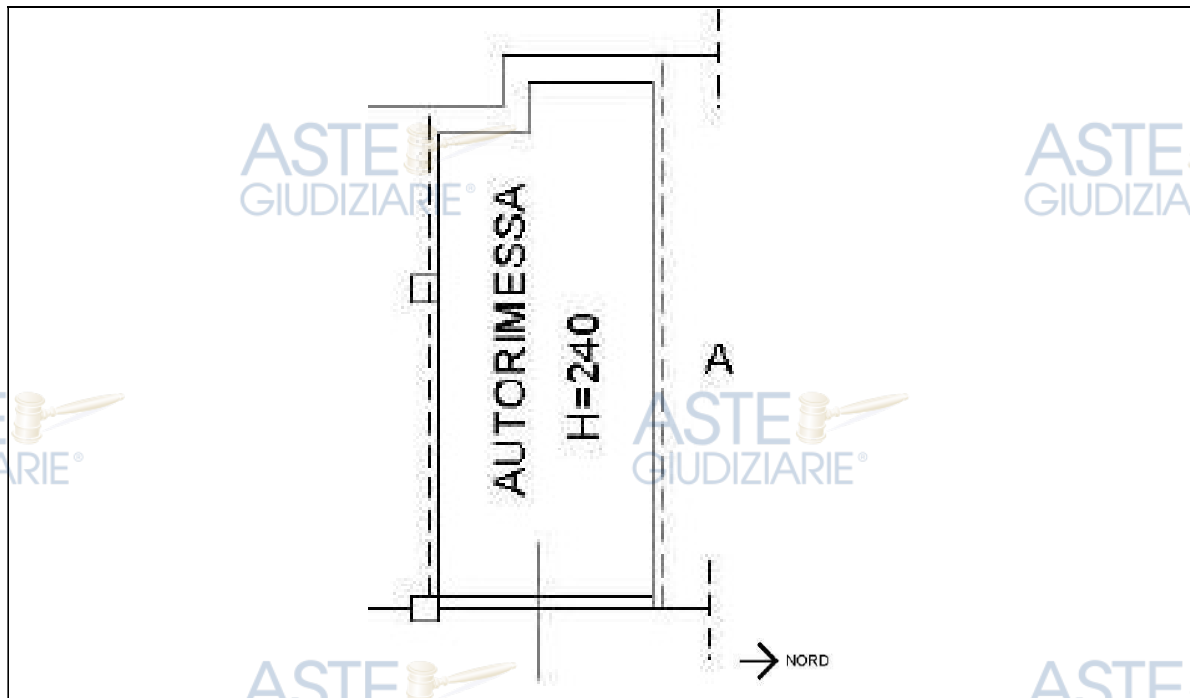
Estratto planimetria catastale Part. 169 sub.18 -piano interrato
